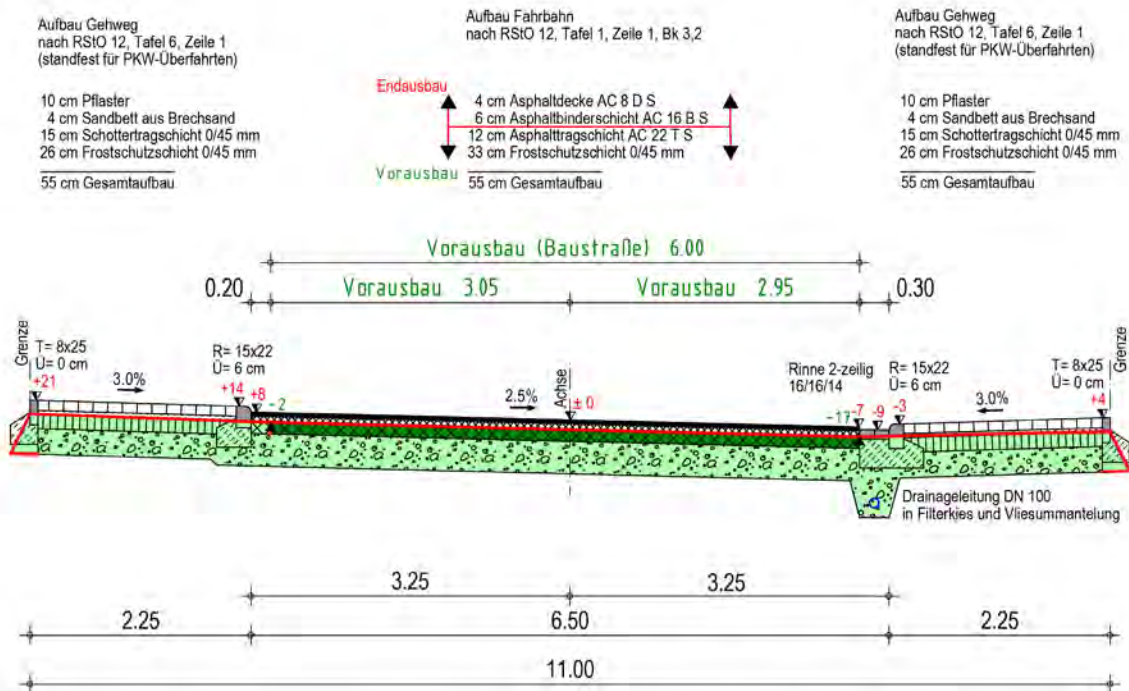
Regelquerschnitte Straße 15 A (südlich im Plangebiet)
